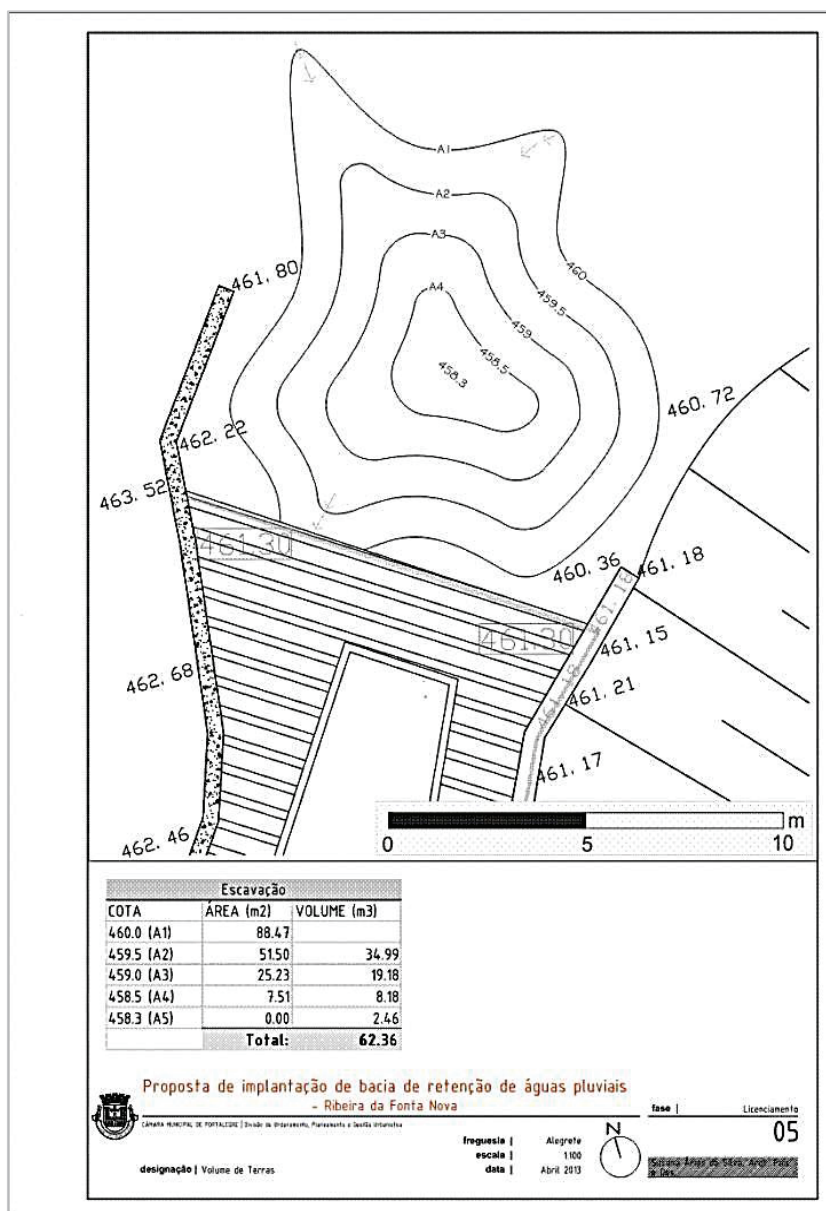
Planta de implantação - 04 - Proposta de implantação de Bacia de Retenção de águas pluviais - Ribeira da Fonte Nova em Alegrete
